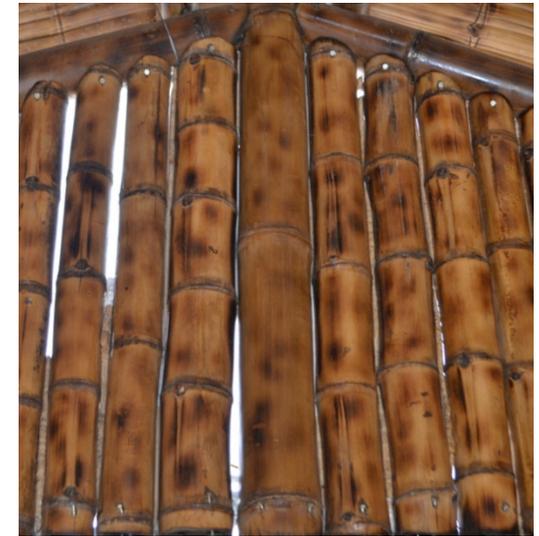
Detalle interior del techo, oficina de bambú. Fuente: propia
